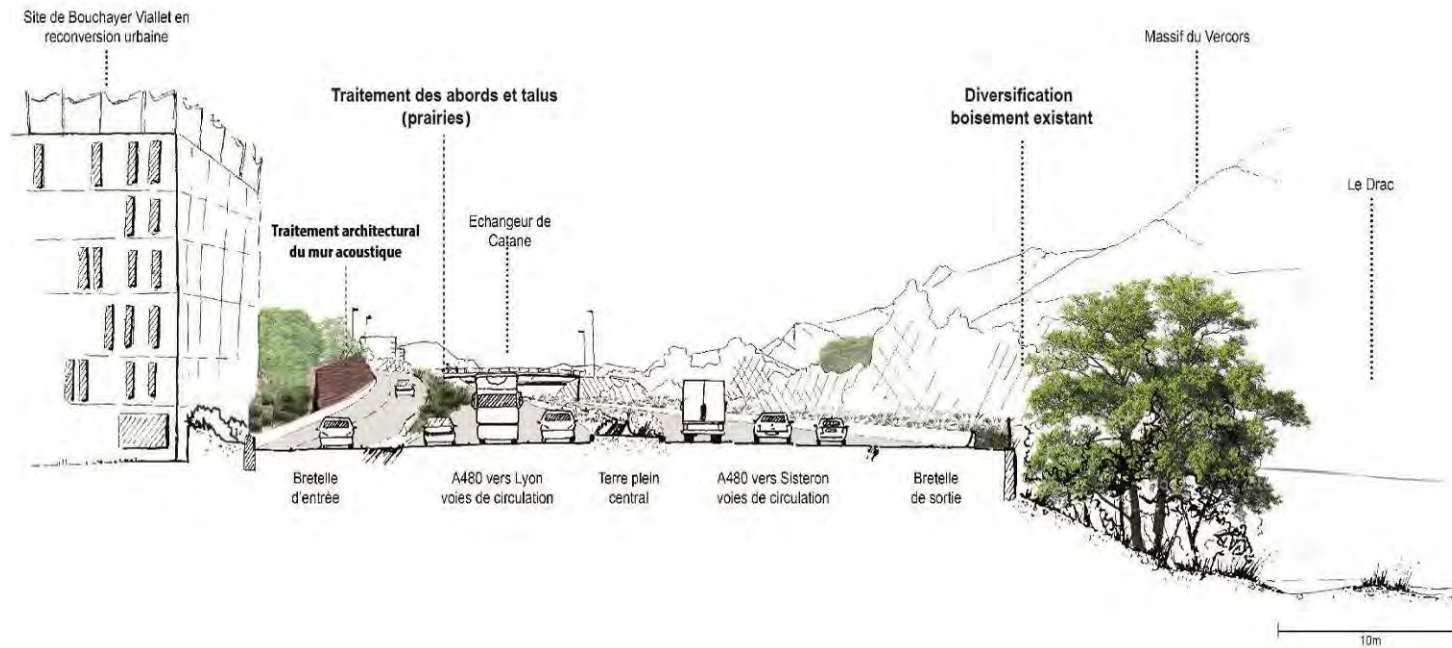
Profil en travers n°3 - Bouchayer – Viallet – profil état projet (© Ingerop)
